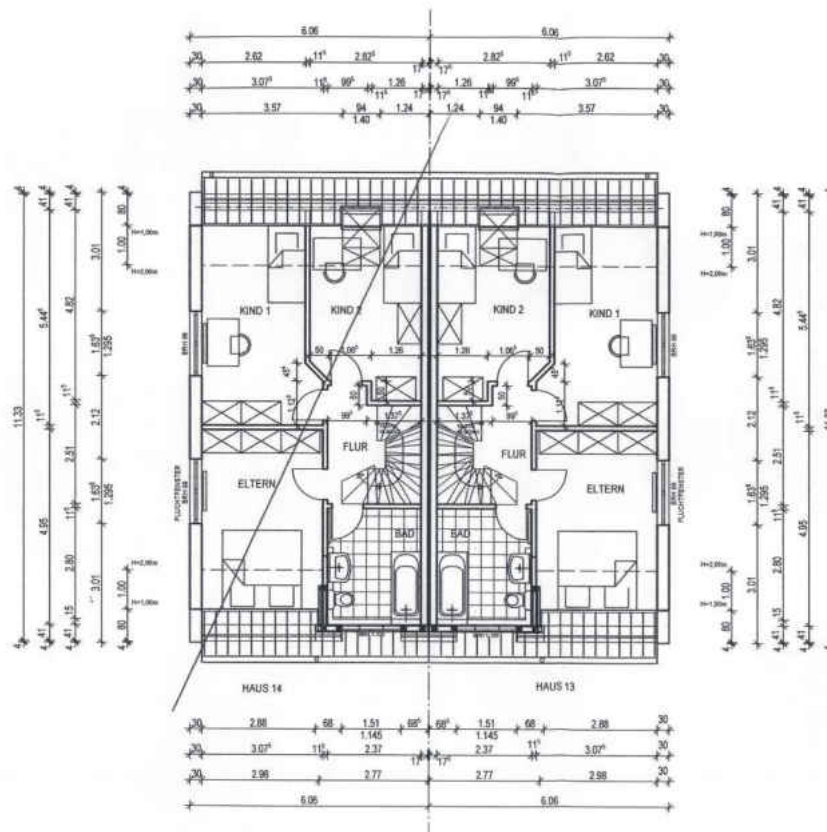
Grundriss vom Dachgeschoss
